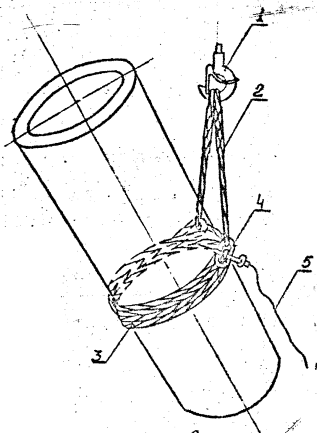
Схема подъема анкерно-целовых железобетонных опор краном К-5363
